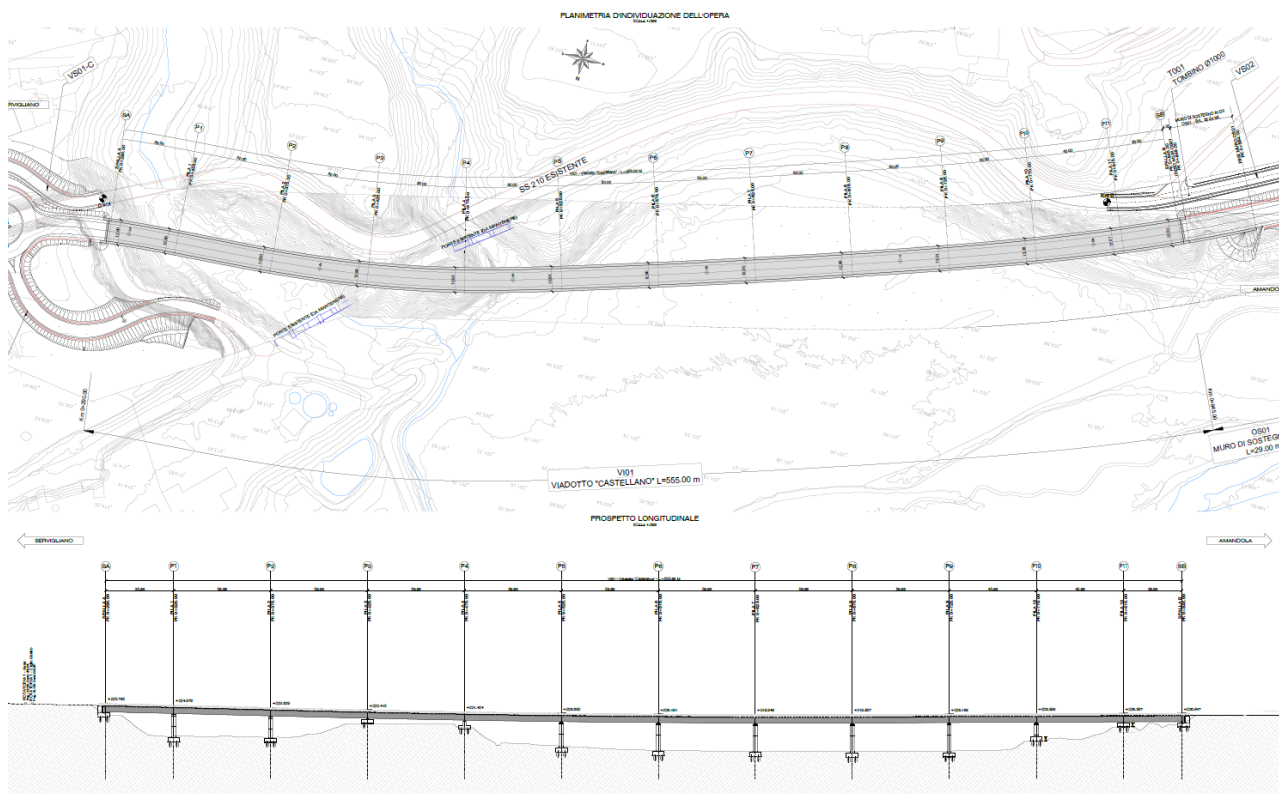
Planimetria e profilo longitudinale – Viadotto Castellano VI01.
